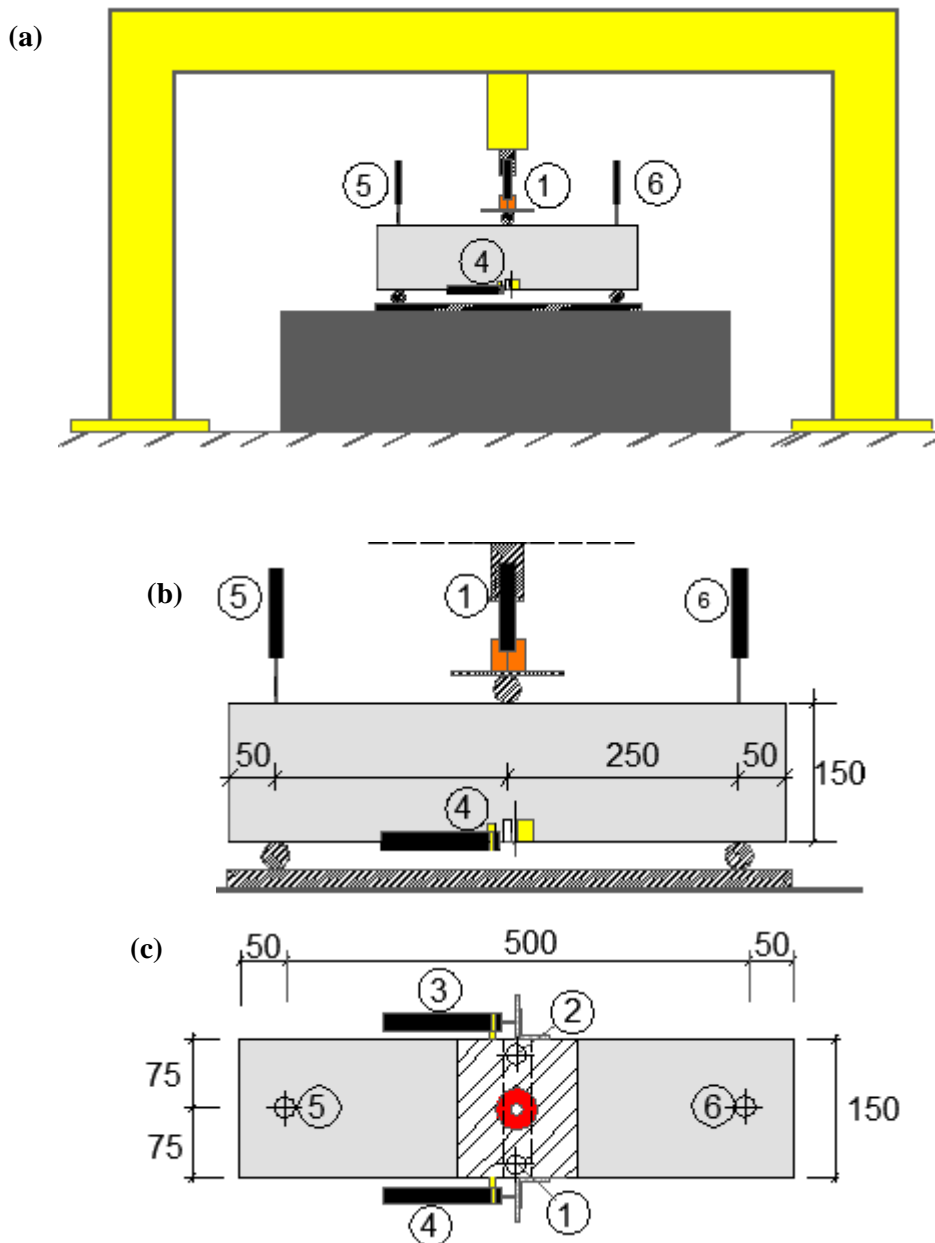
Localização dos deflectómetros nas vigas, (a) vista geral, (b) vista lateral da viga e (c) vista superior da viga (desenho sem escala e dimensões em mm).
